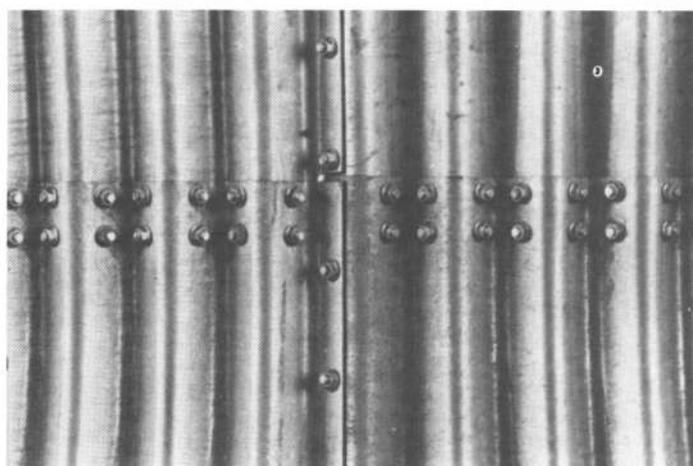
Joint à recouvrement boulonné en flanc d'onde
